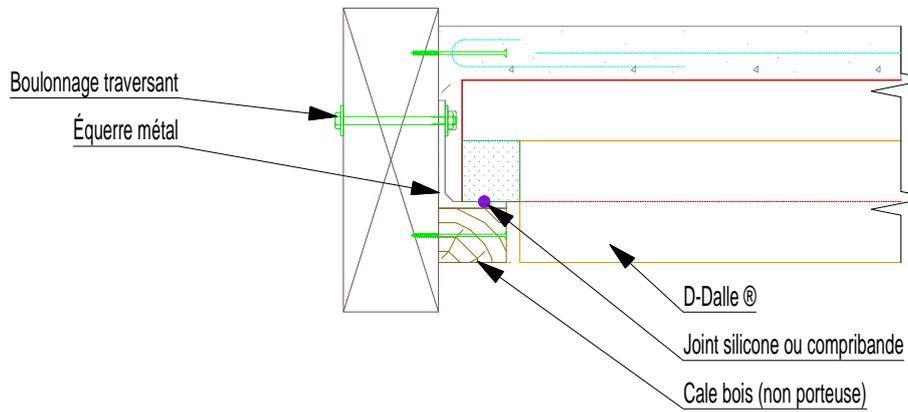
Détail d'appui sur mur porteur bois par muraille
